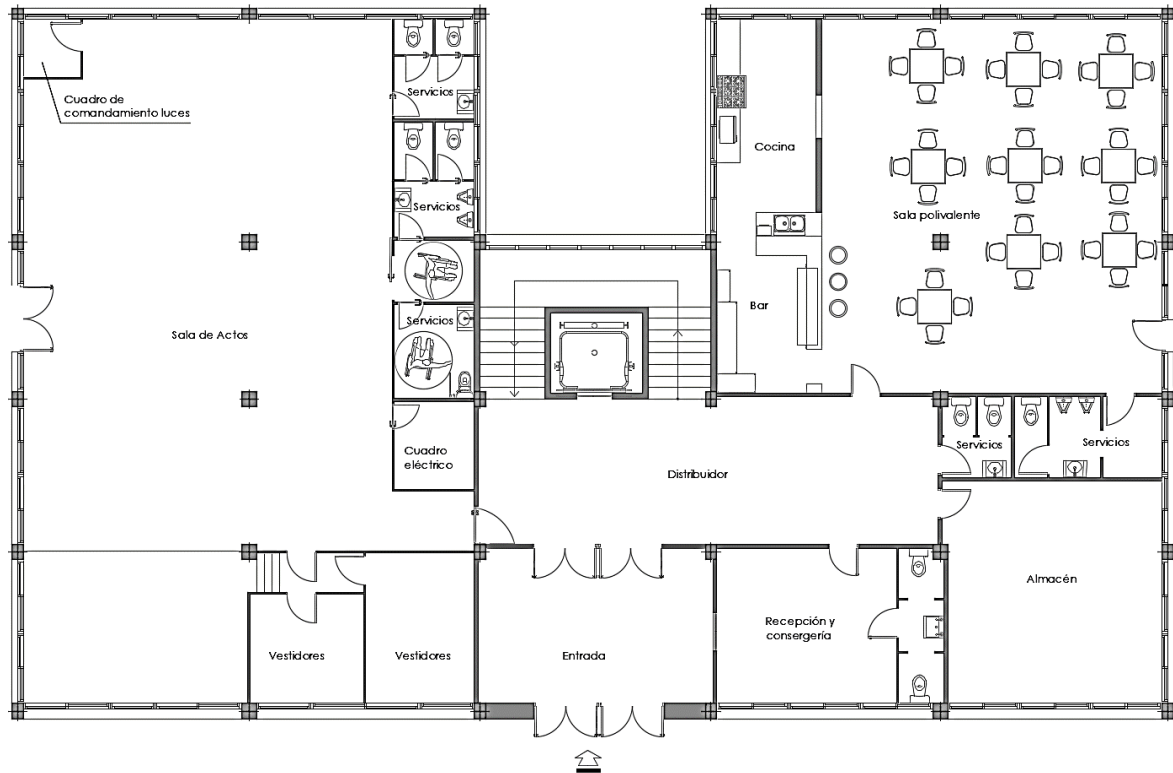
Estado actual - Distribución Planta Baja AutoCAD
